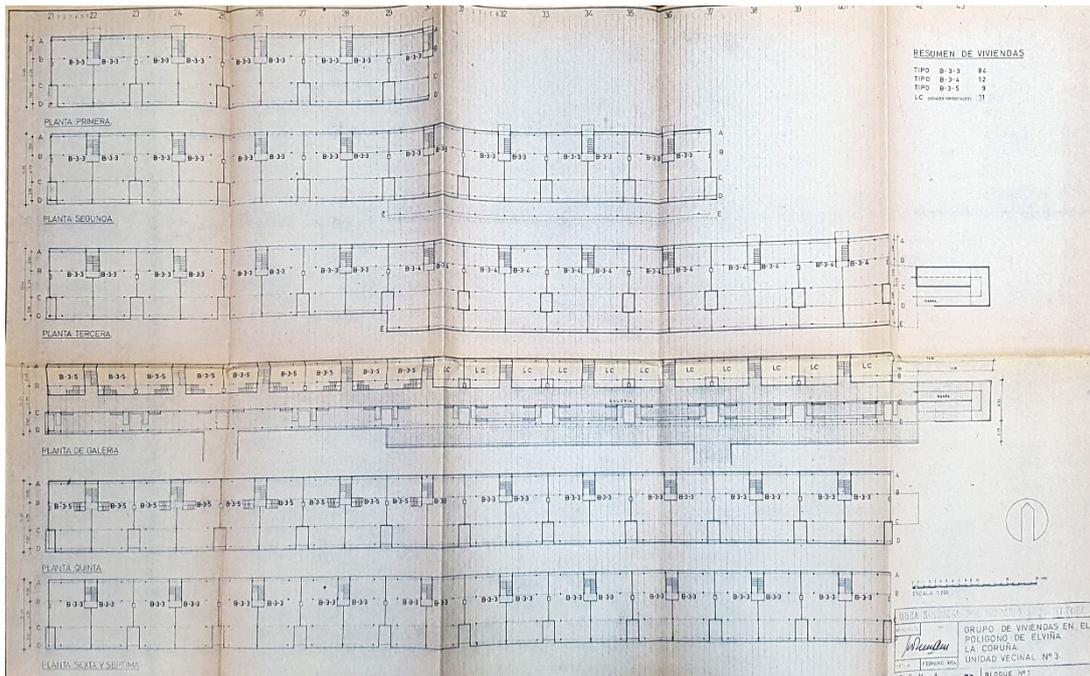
Plantas Bloque N°1. 1964. Fuente: Archivo Municipal da Coruña
